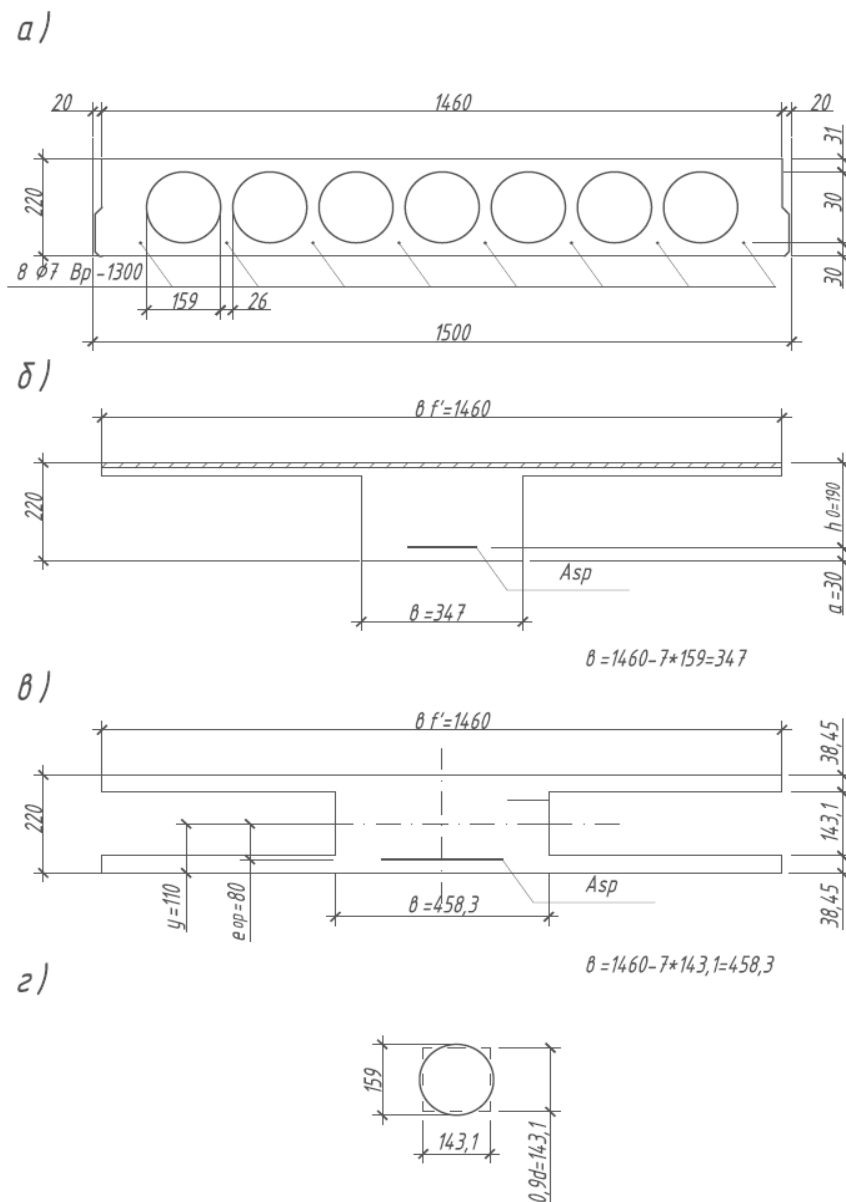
Поперечные сечения плиты с круглыми пустотами: а- основные размеры; б- к расчету по прочности; в- к расчету по второй группе предельных состояний; г- к расчету эквивалентного сечения
